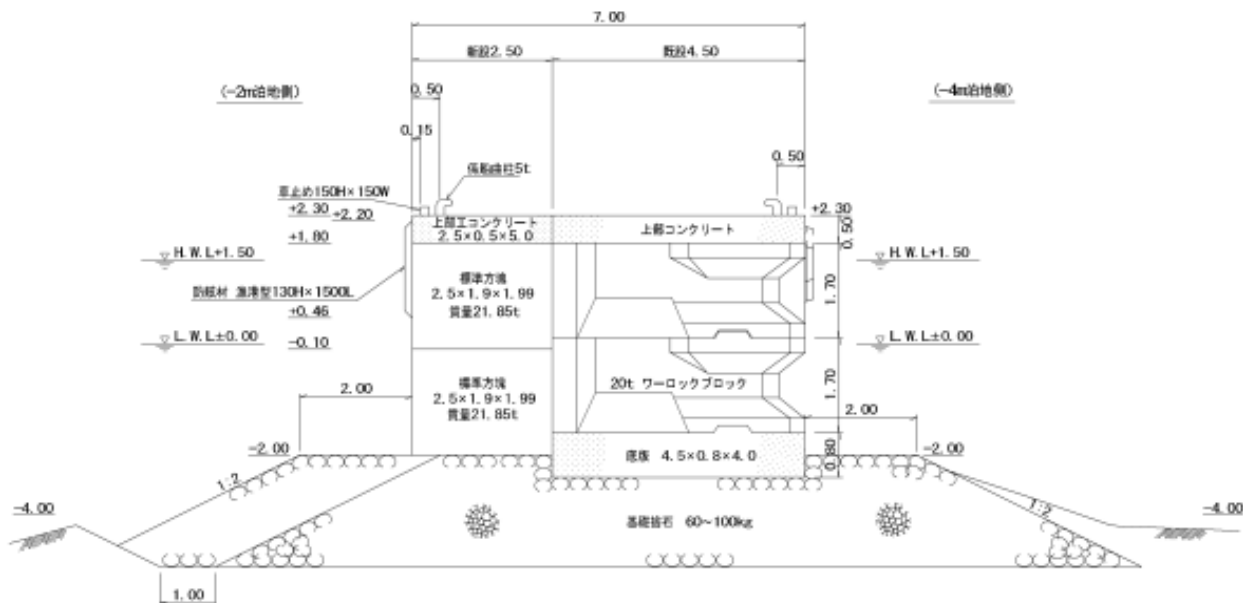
265 No.26 大洗港区\_第1ふ頭地区 F 物揚場の断面図 (被災前)
